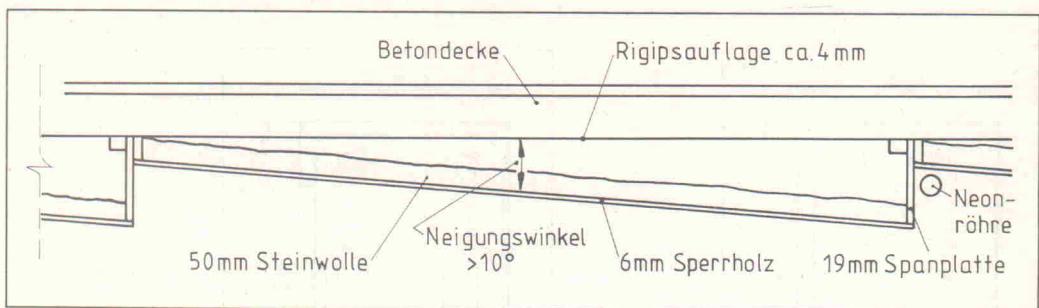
Deckenkonstruktion mit sägezahnartig montierten Sperrholzplatten.
